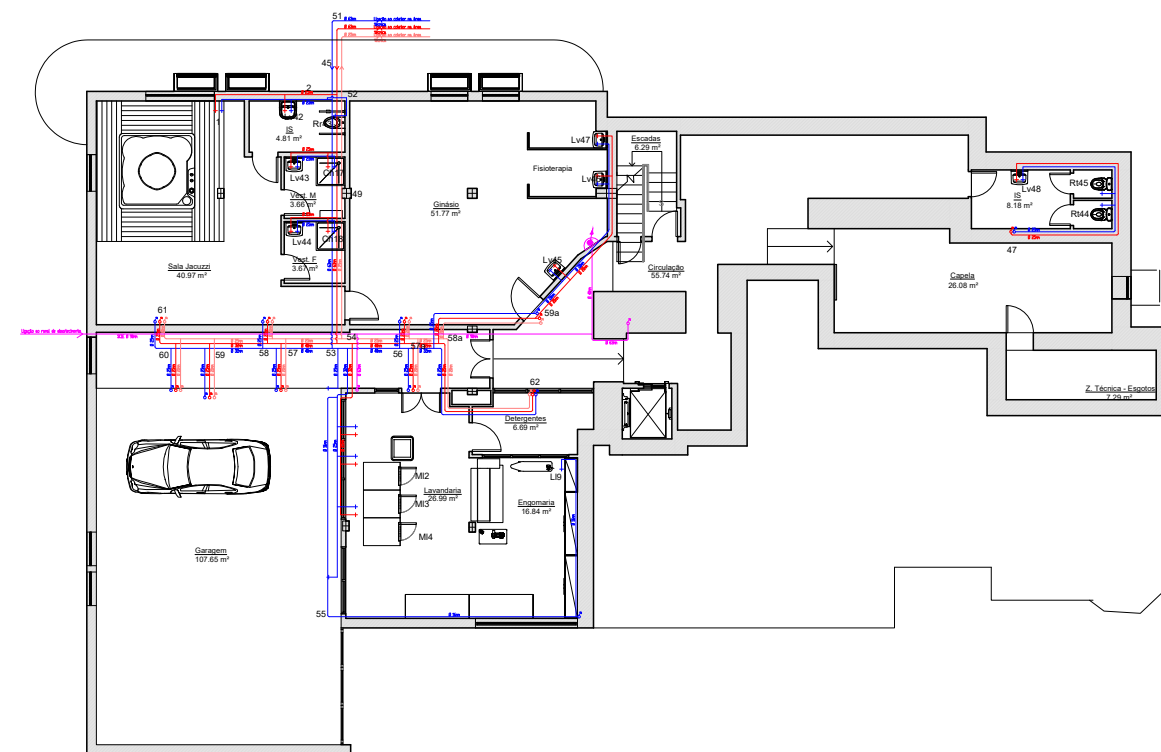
Rede de abastecimento de água potável agregada, nos edifícios existente e em construção - Piso 0 (Esc. 1/200)
